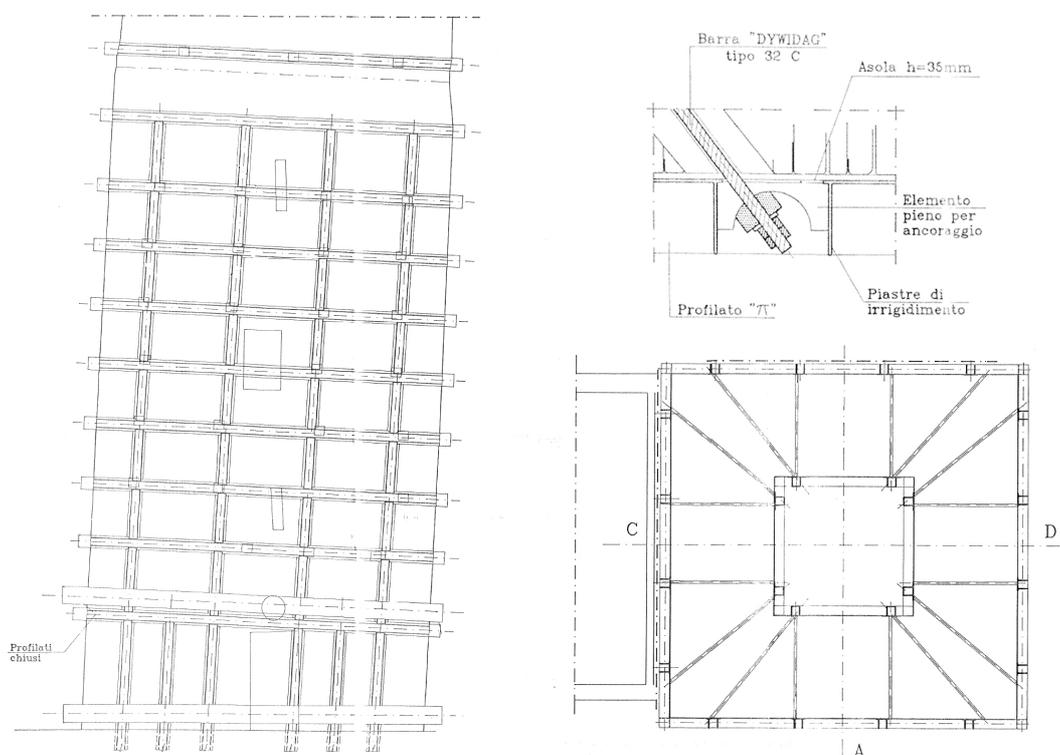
Messa in sicurezza della Torre Civica a Ravenna: prospetto, pianta e particolare [2]
